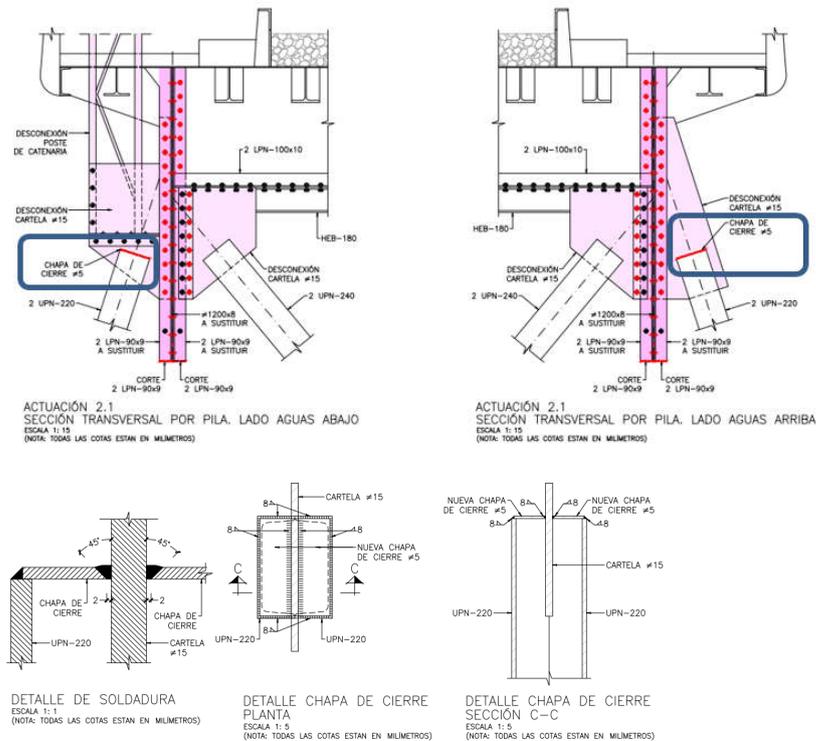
Nudo superior mamparo de pila. Cierre de contravientos.
